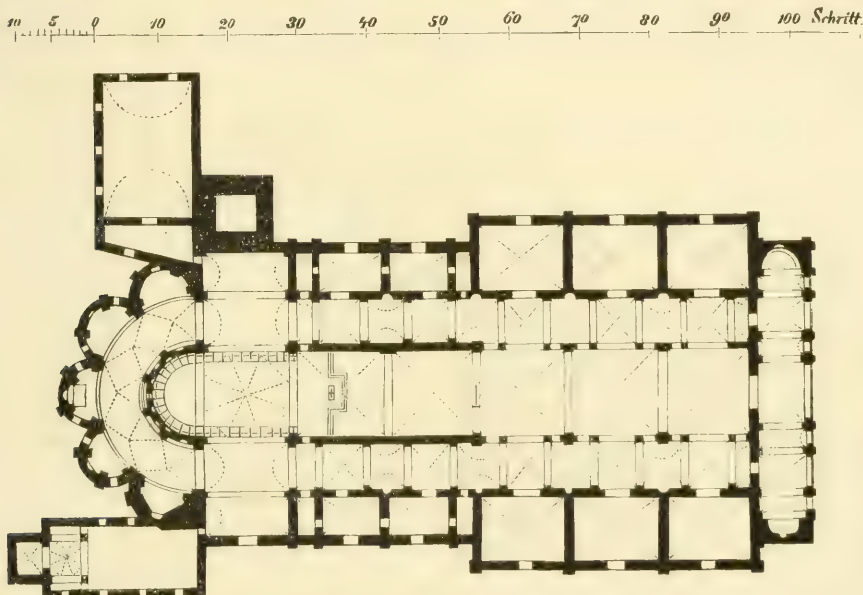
Grundriss der Kirche in S. Benedetto. (M. Lohde.)
